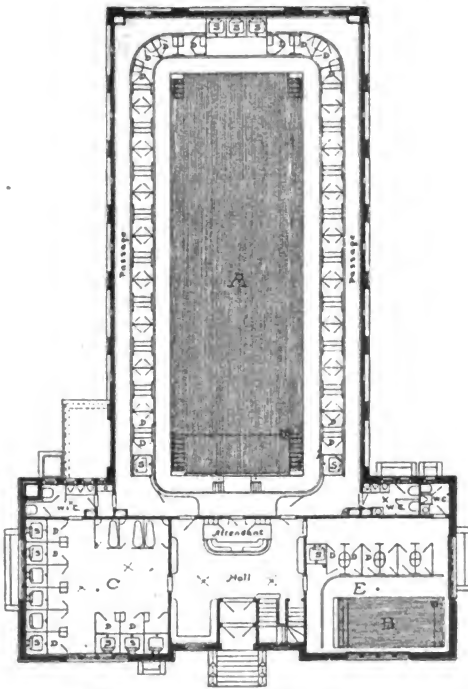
Öffentliches Bad in Brookline; Grundriß.
